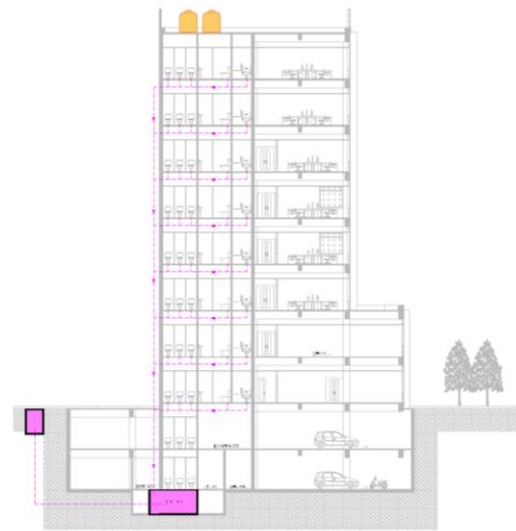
Denah Pengaliran Air Bersih & Air Daur Ulang
